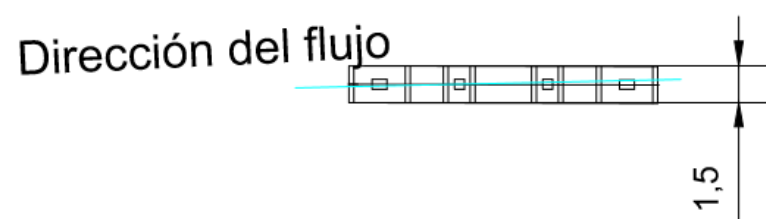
Dirección del flujo con la pila (Fuente: AutoCAD).
